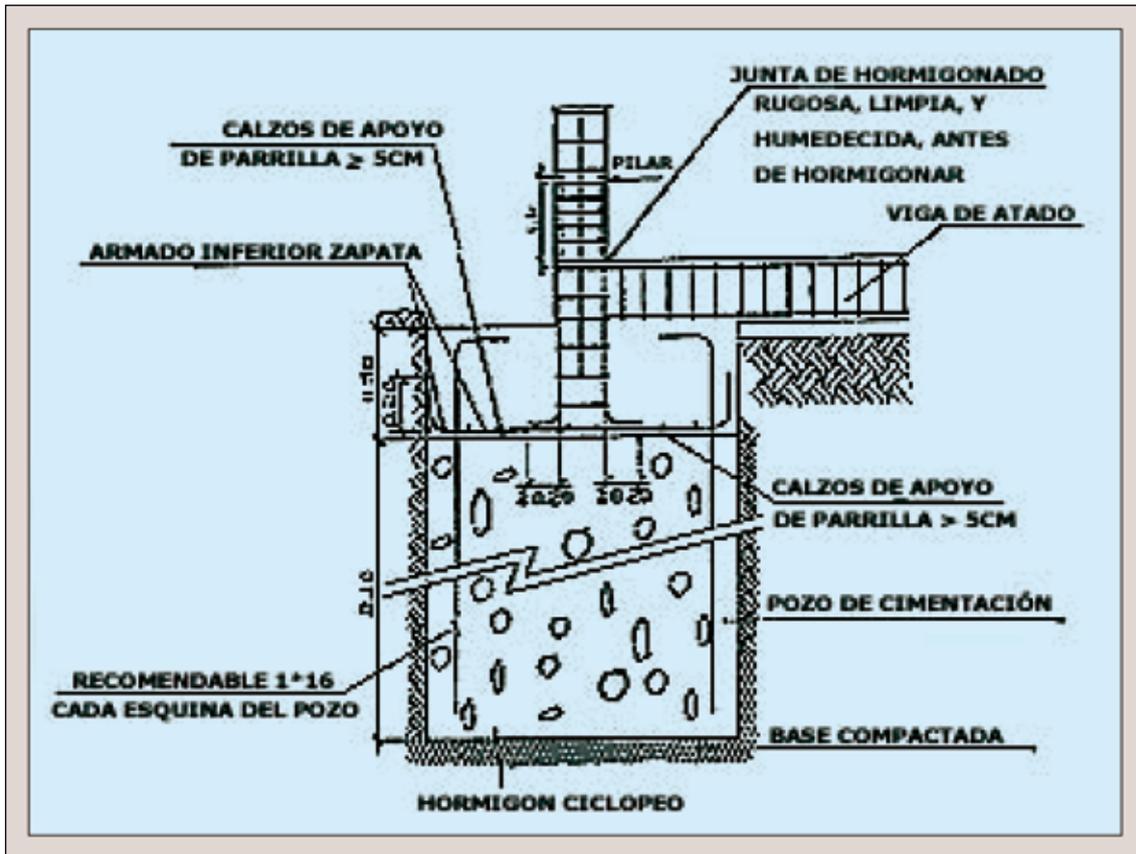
Zapata sobre pozo de hormigón pobre armado (ASEFA. 2004).
